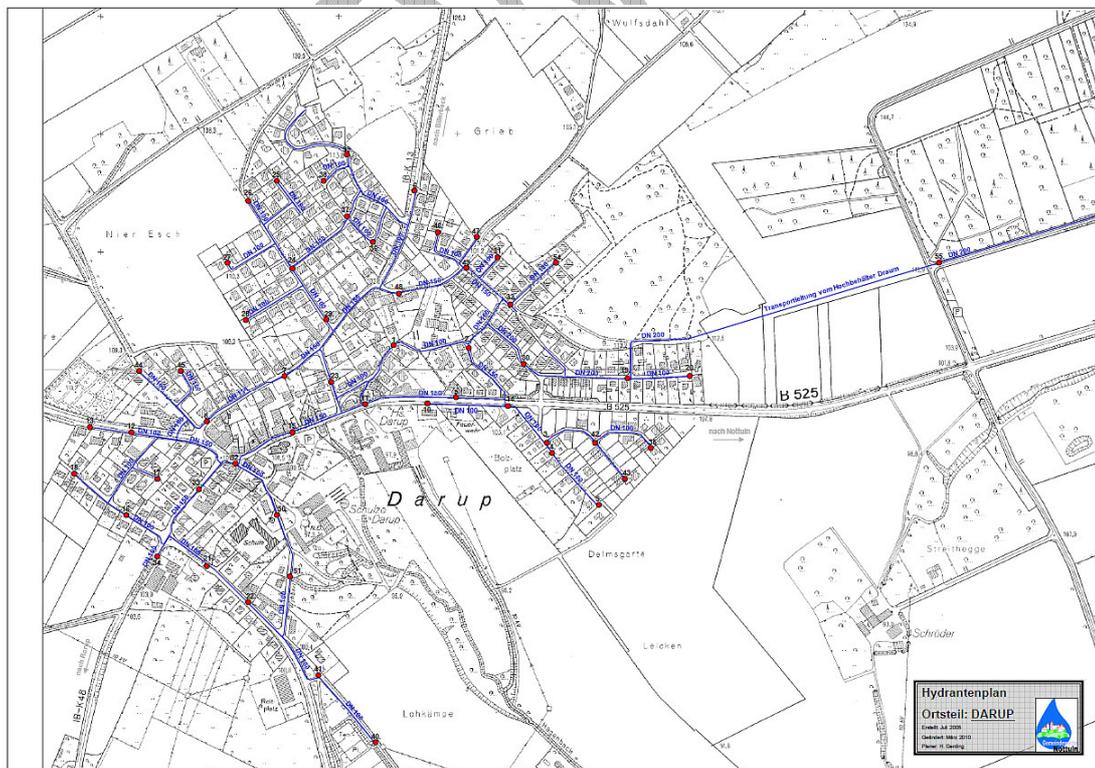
Trinkwasserversorgungsnetz mit Hydranten, Detailplan Darup
